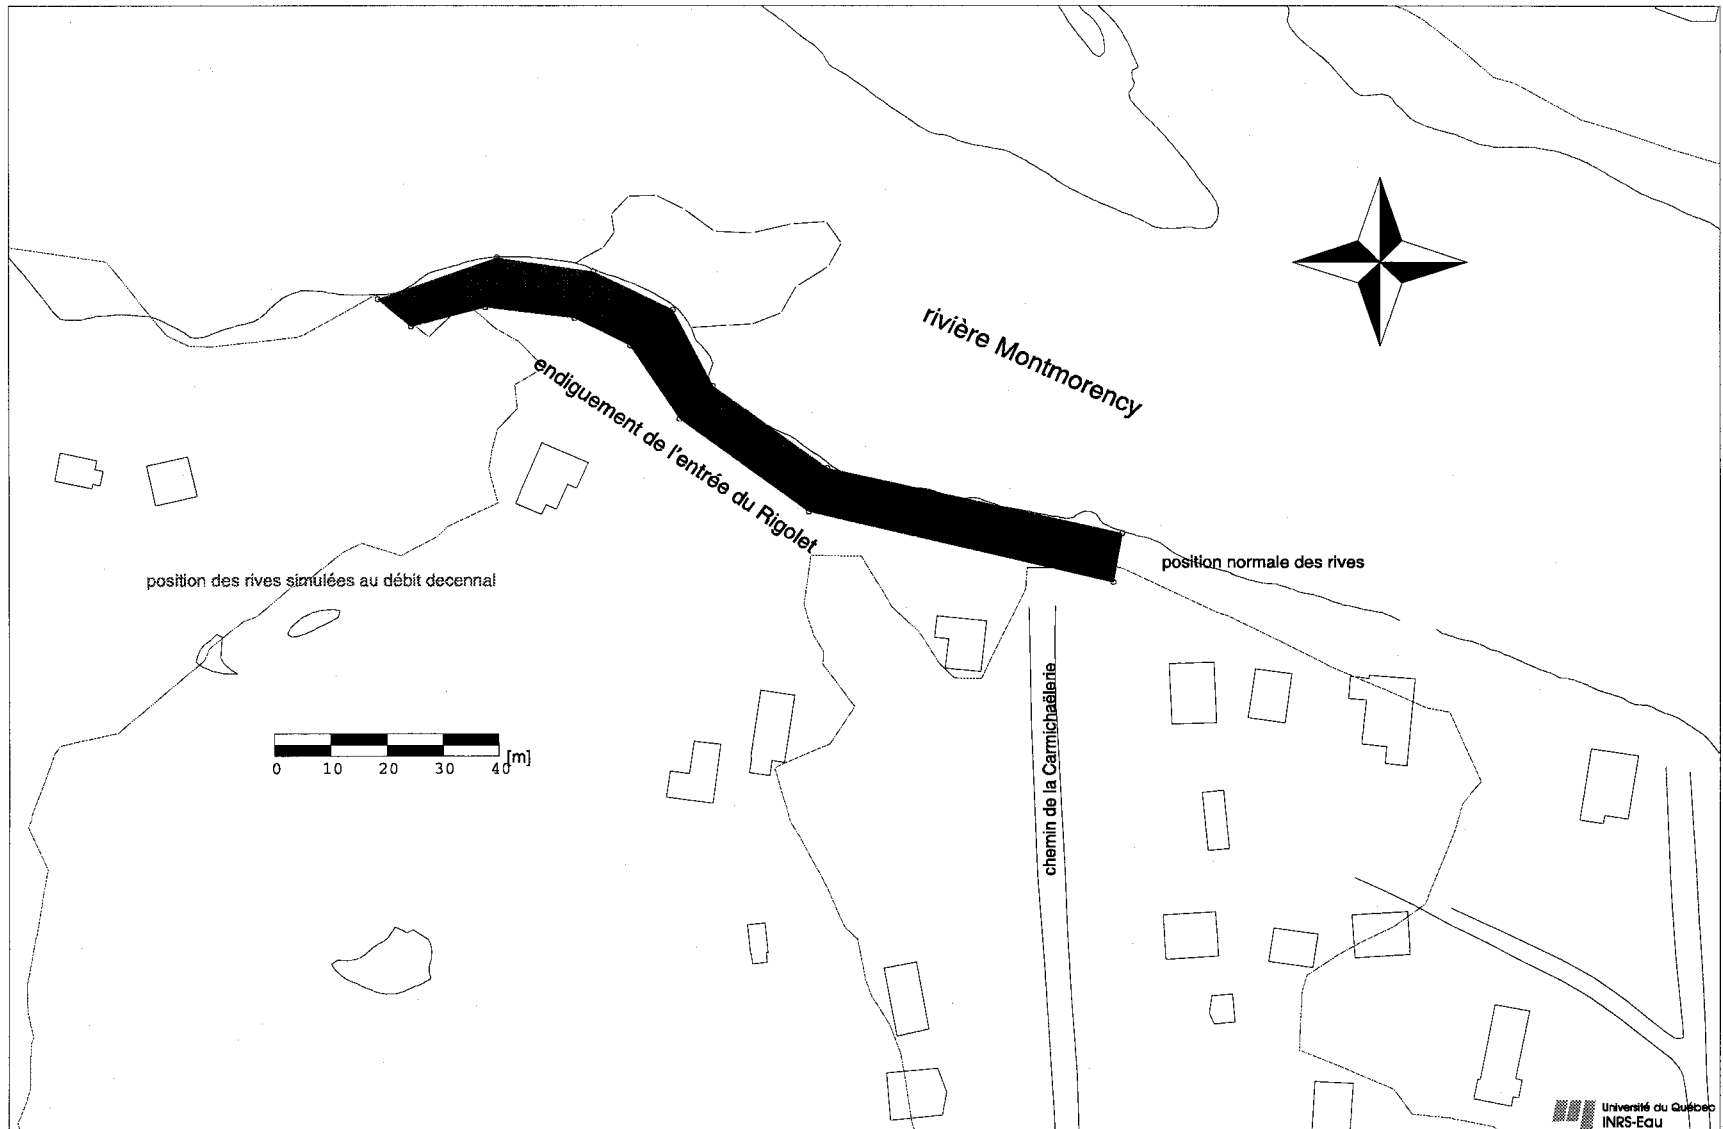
Vue en plan de l'endiguement de l'entrée du Rigolet.
